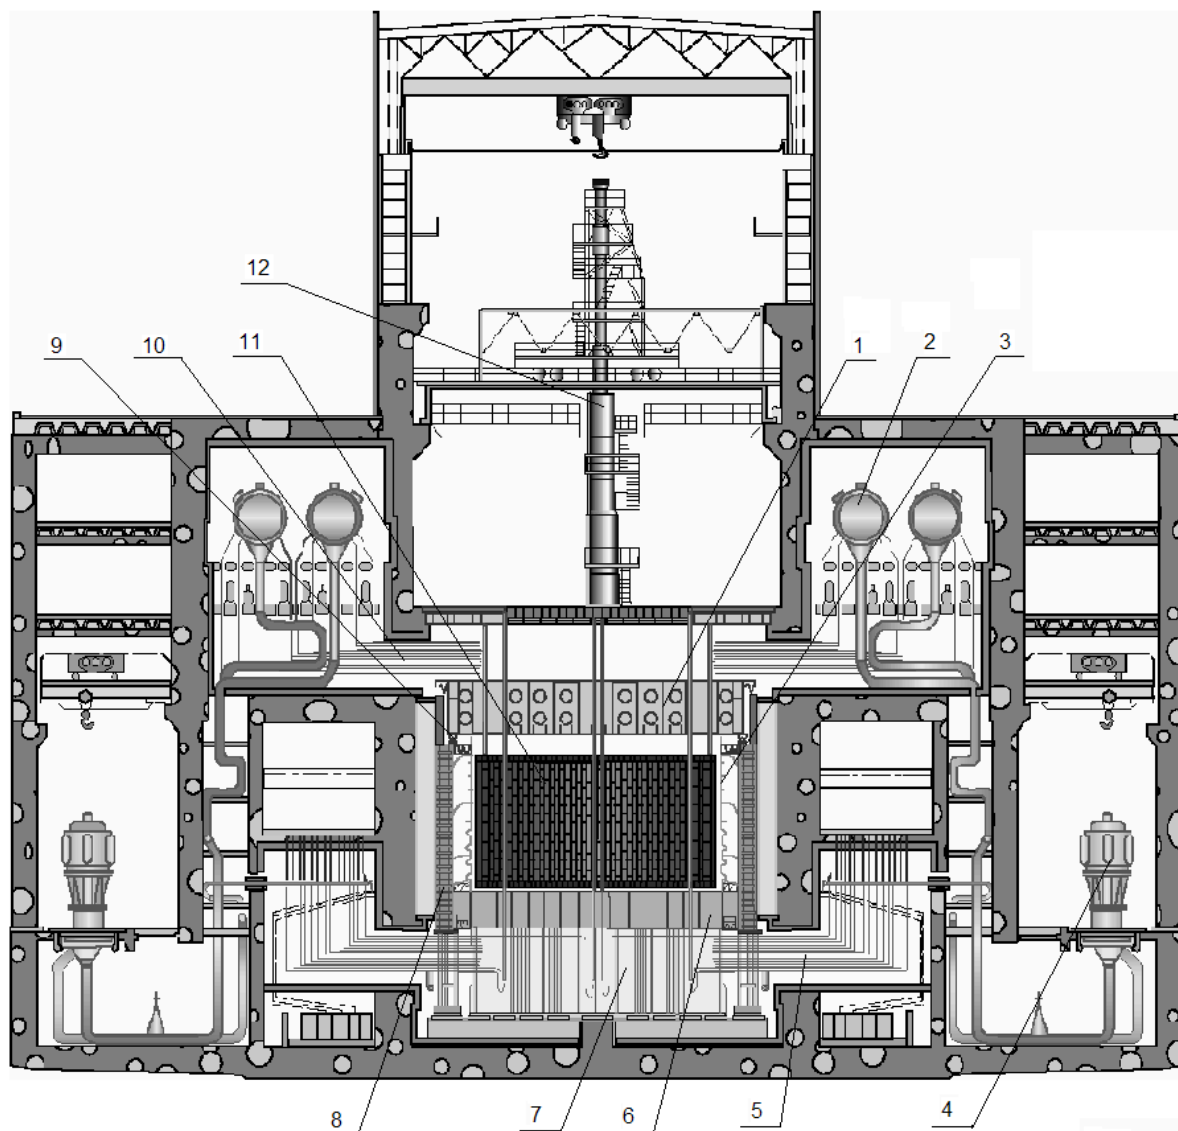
Загальний вигляд реакторної установки з реактором РБМК:
